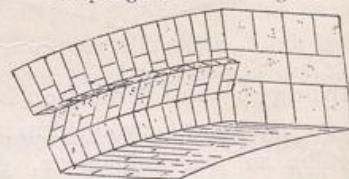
Eingreifen leichter Gewölbe mittels »Zahnung«.
